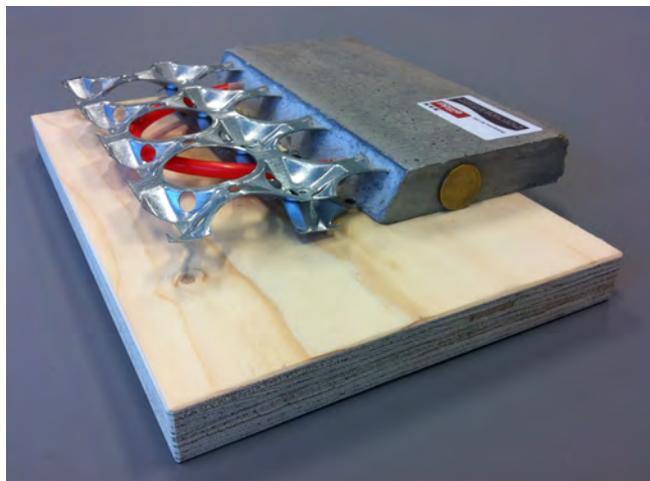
Modell Fließestrich mit 50 Cent Münze zum Vergleich. Der Estrich würde auf einer PE Folie und Trittschalldämmung eingebaut werden.
